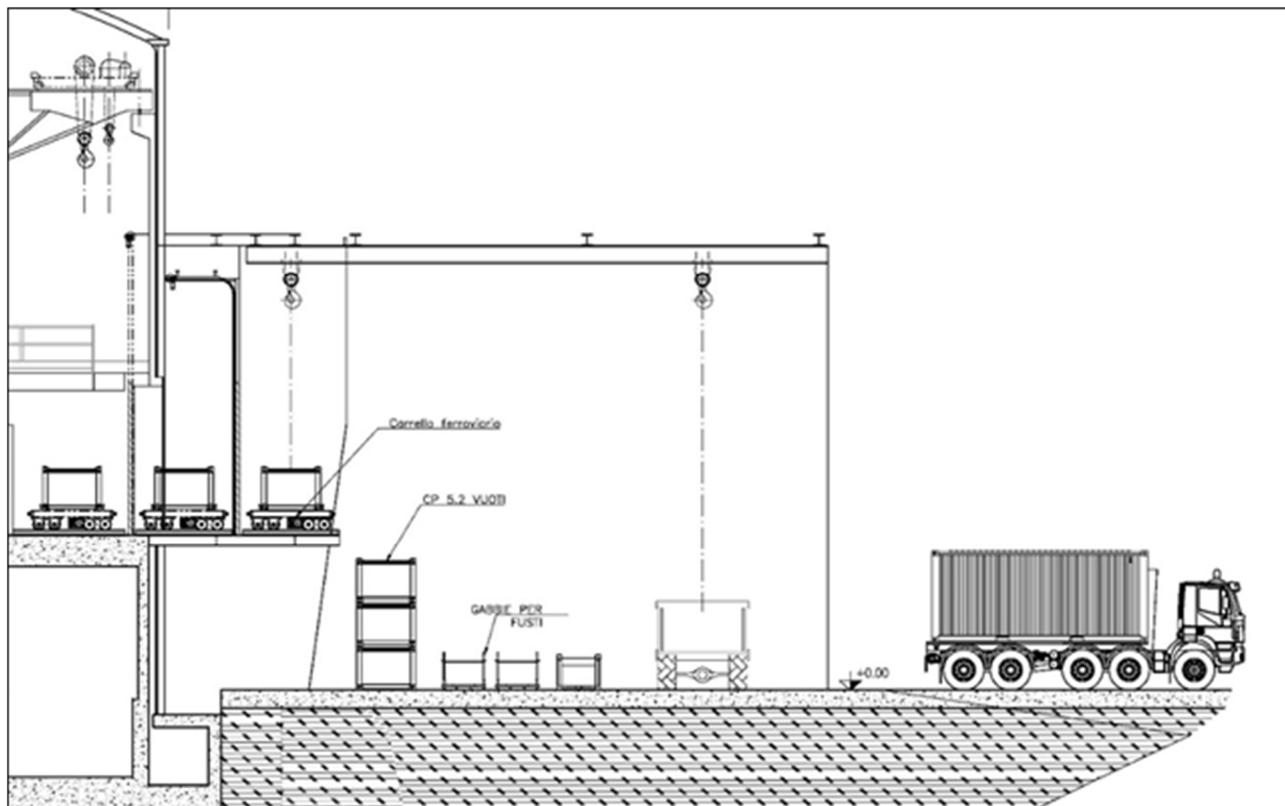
Layout sistemazione accesso lato Sud al Contenitore Stagno (vista)
